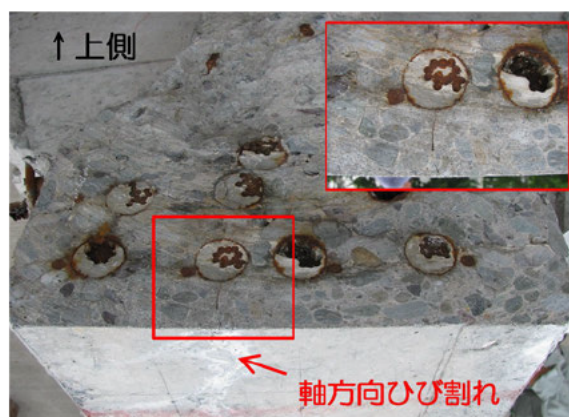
主桁下面に生じたシース沿いひび割れ
